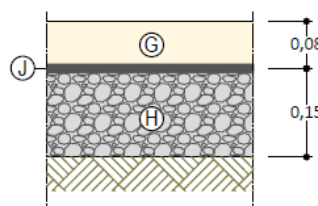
Pormenor do pavimento tipo VI - Ciclovia
